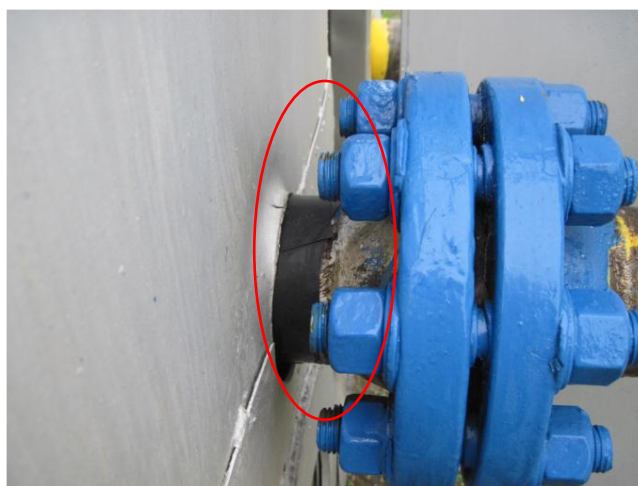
Недостаточное расстояние от сварного соединения до стены здания ГРС
